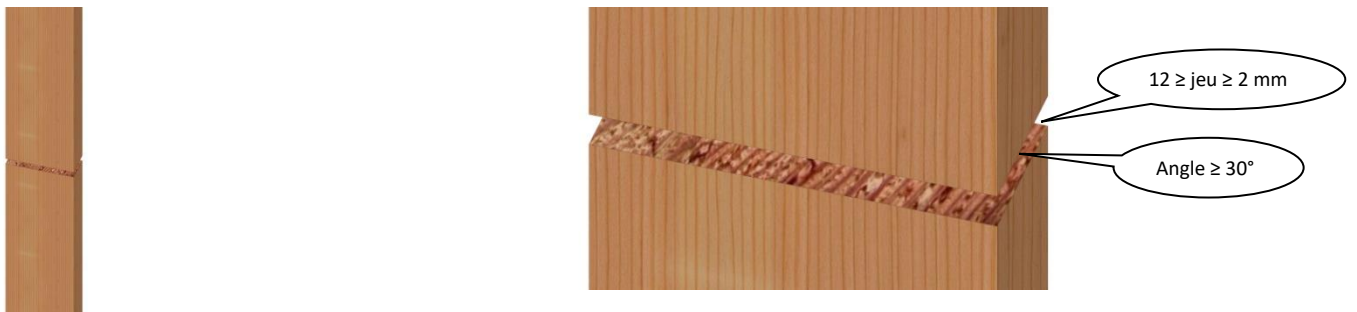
Raccordement en bout des lames lors d'une pose verticale (Cadwork)
